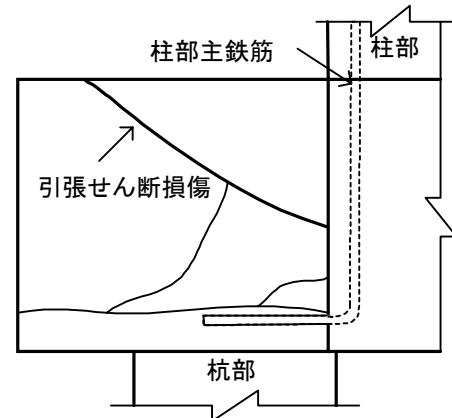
フーチング断面でのひび割れ状況 (No.4)
